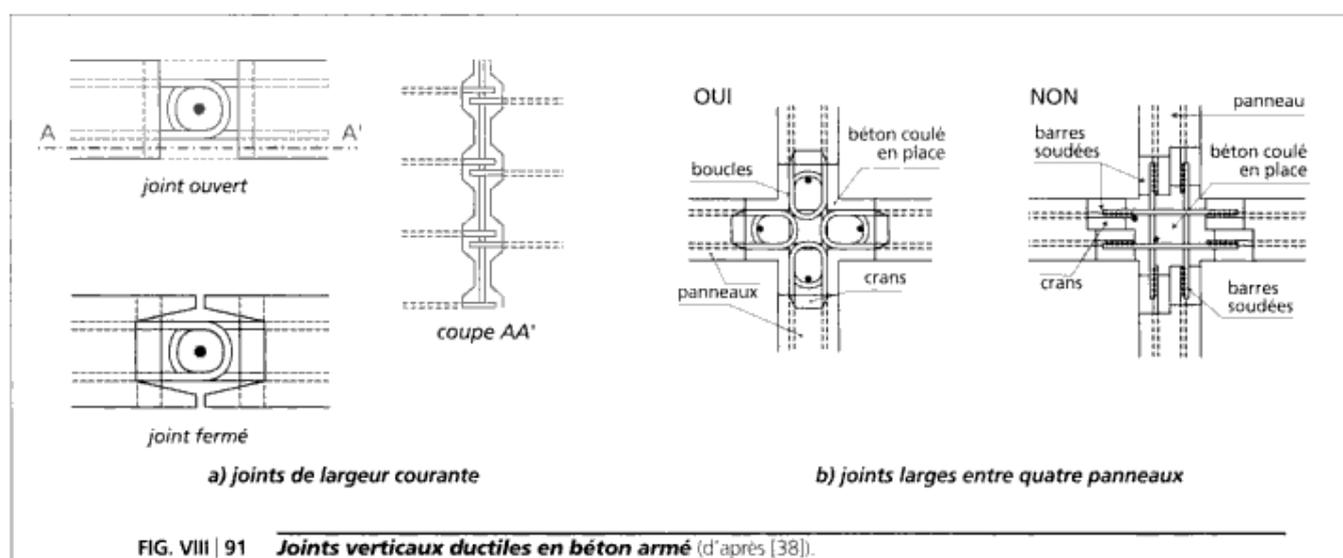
Joints verticaux ductiles en béton armé (d'après [38]).
